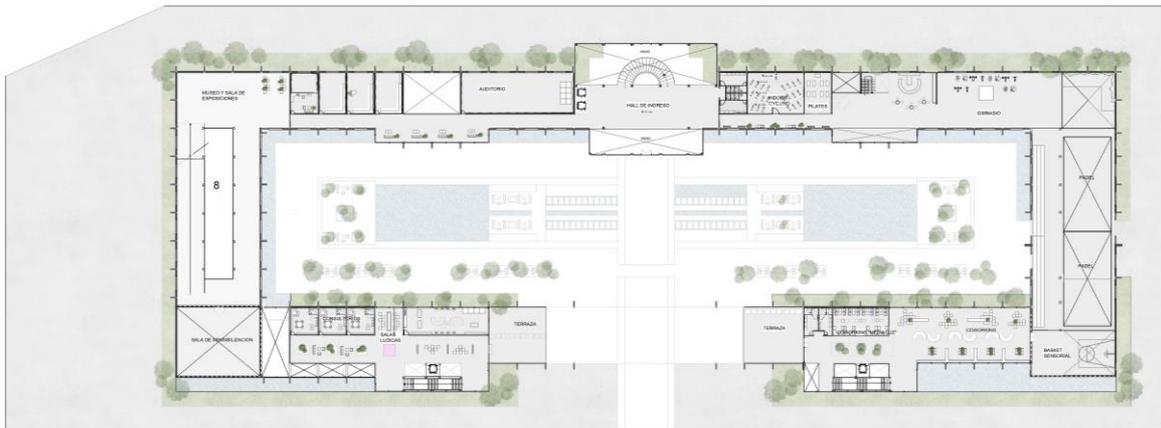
Planta alta 1 N=+3.96. Elaboración propia
